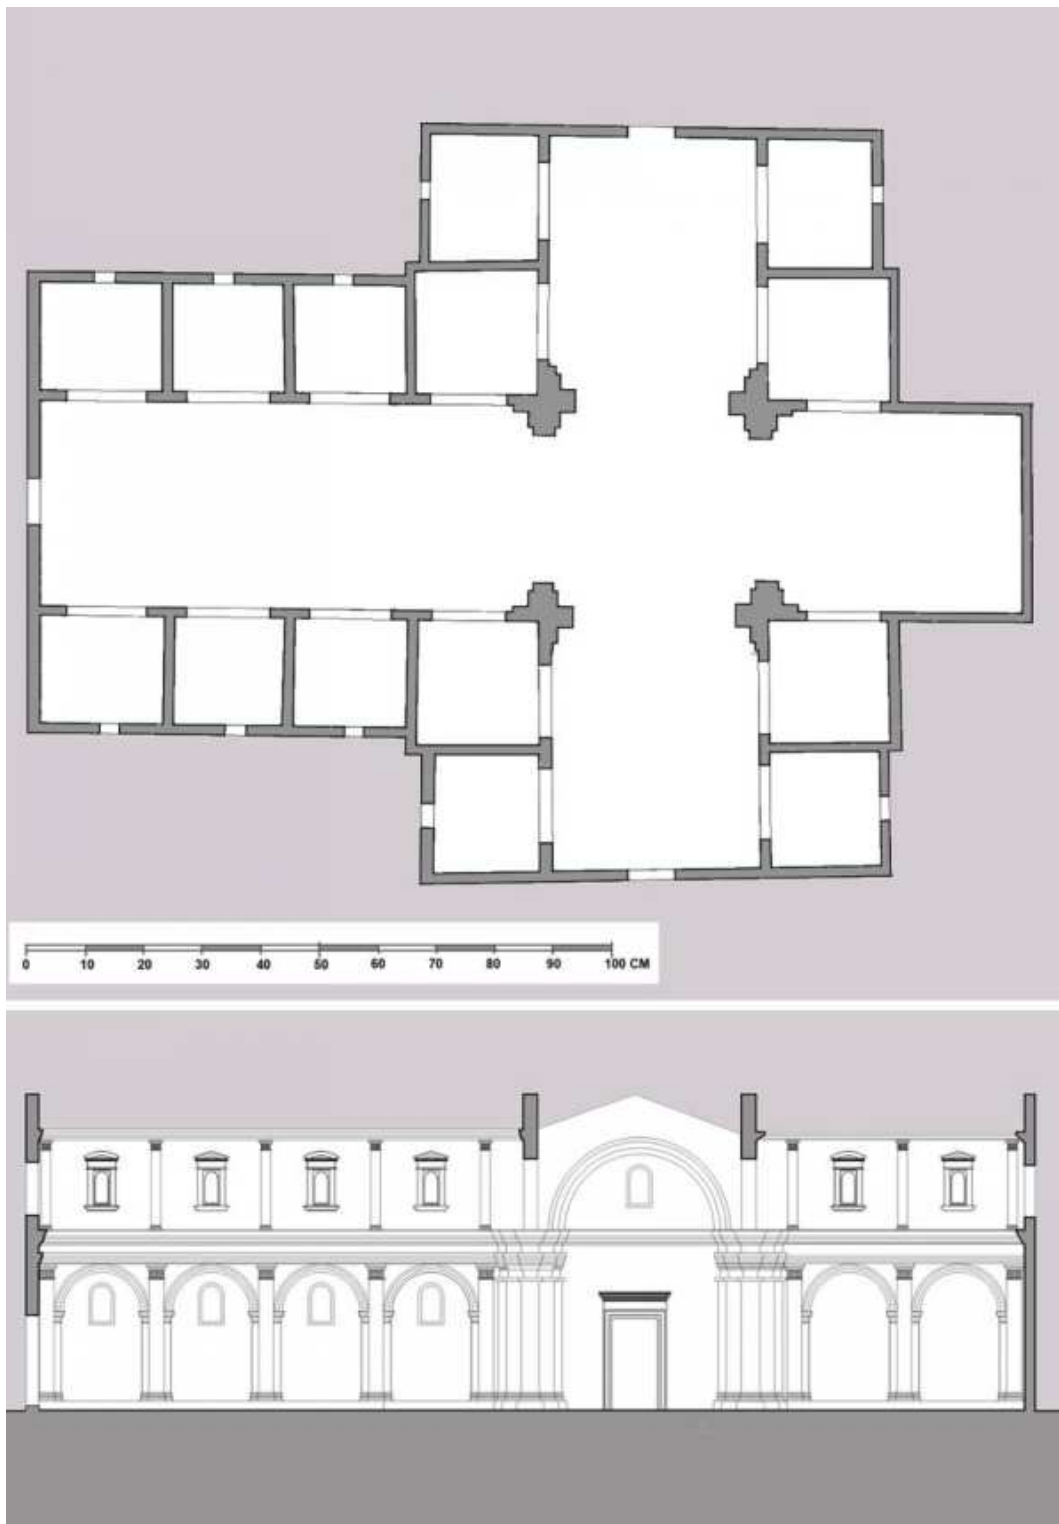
A- Pianta del modello ligneo. B- Sezione del modello con ipotesi dell'apparato decorativo.
